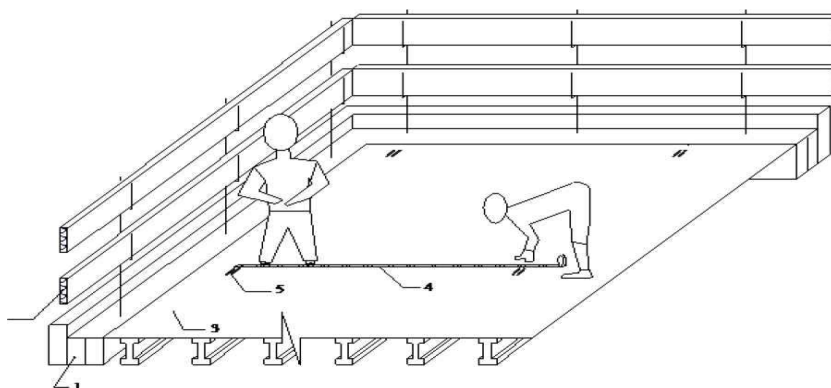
Разбивка палубы при устройстве нижней арматурной сетки: 1 - несущая стена; 2 инвентарное ограждение; 3 - палуба опалубки перекрытия; 4 рулетка; 5 вынесенные на палубу разбивочные оси
